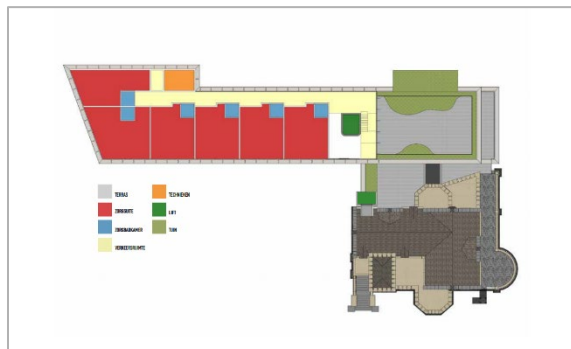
Uitsnede Plankaart met het plan ingetekend
